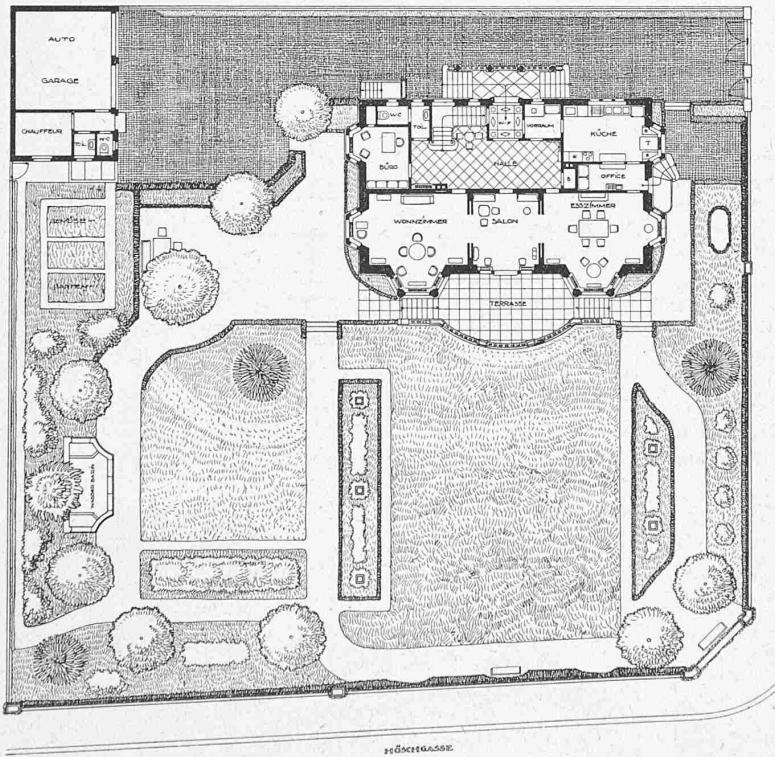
Erdgeschoss-Grundriss mit Gartenplan der Villa Arbenz. — Maßstab 1:400.
